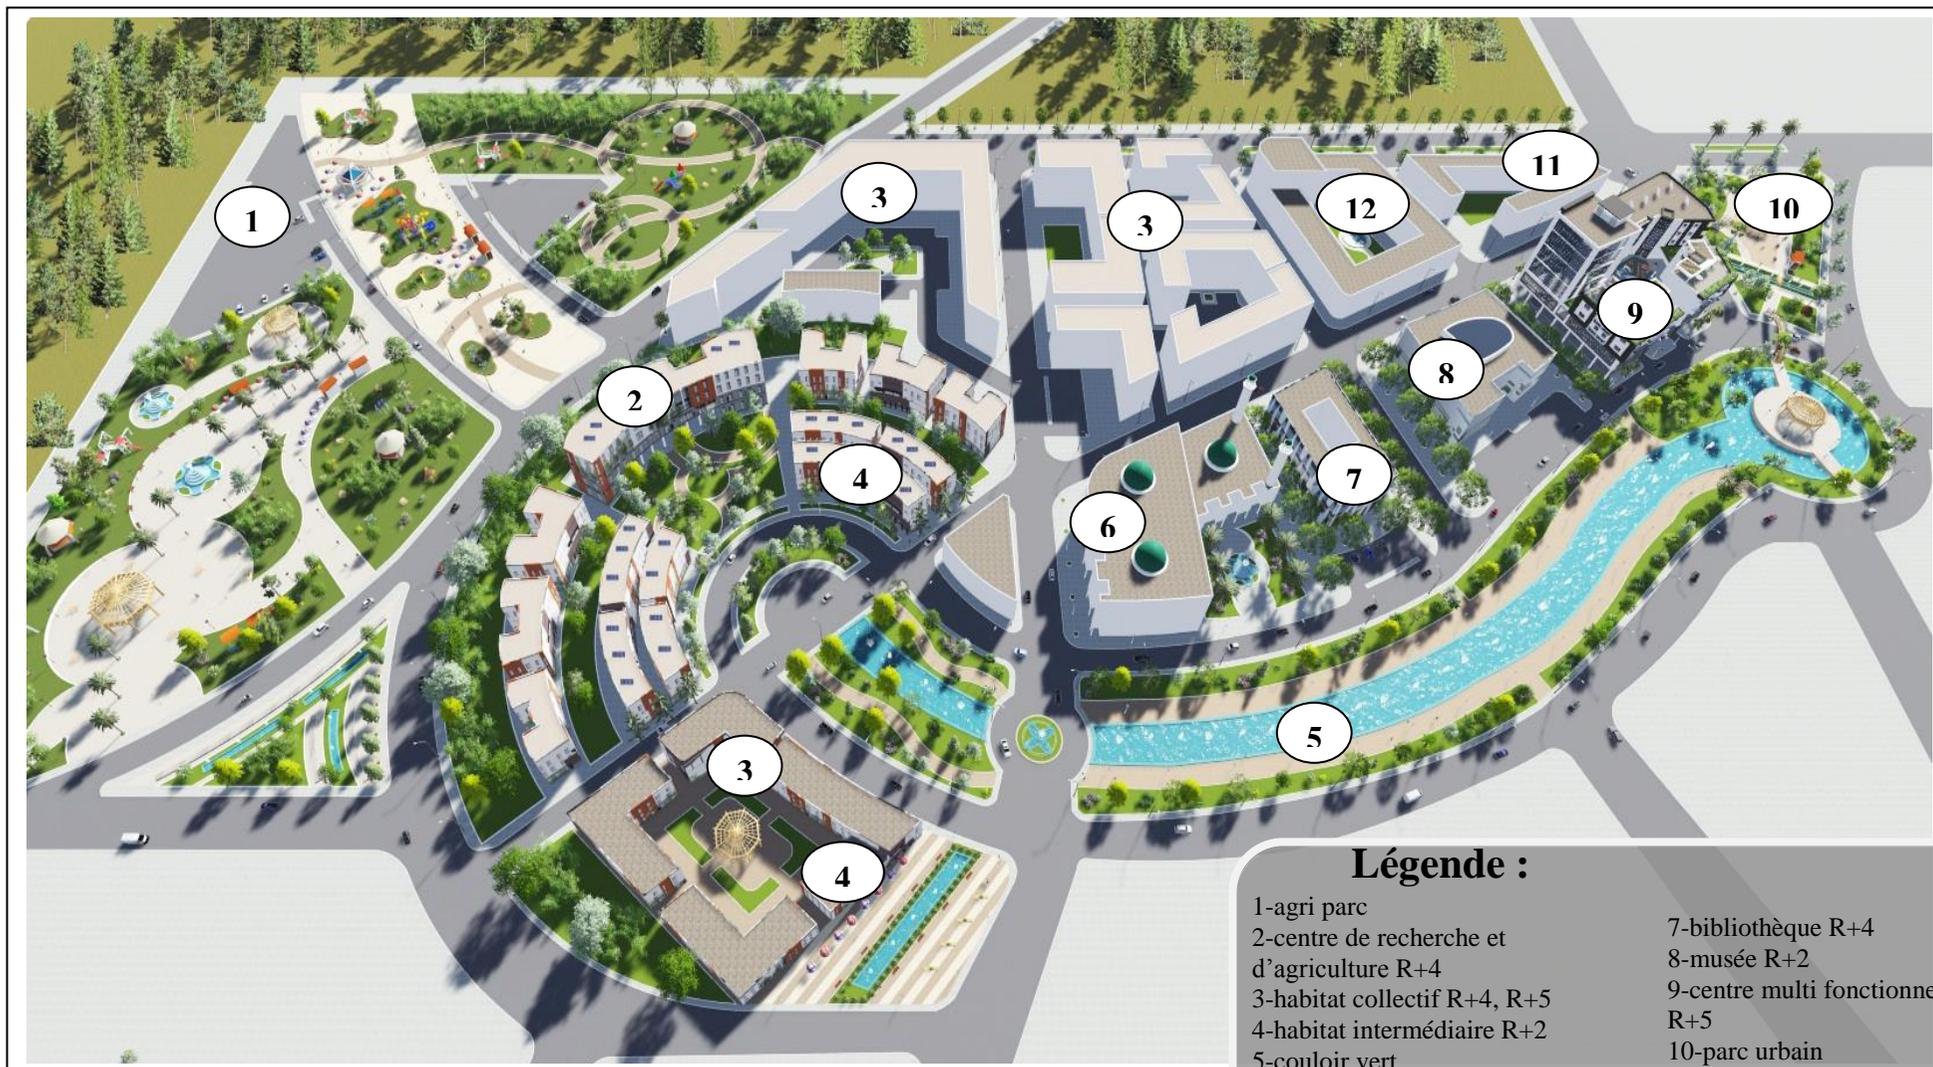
plan d'aménagement ,travail d'auteur année 2016
